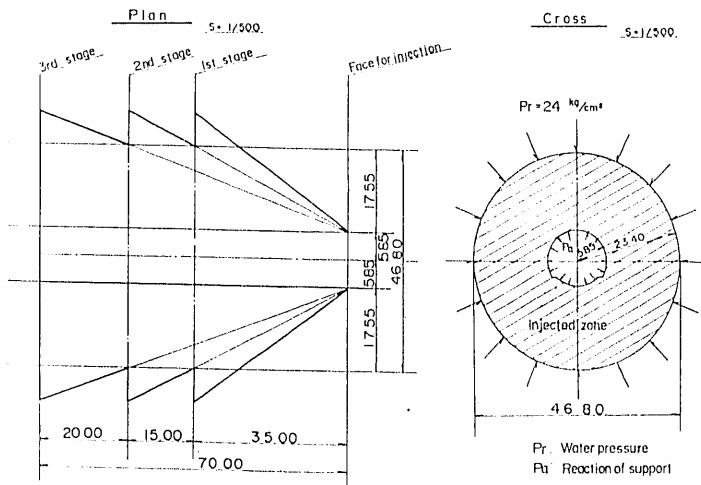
Esquema de inyección (Seikan). Planta y alzado.
